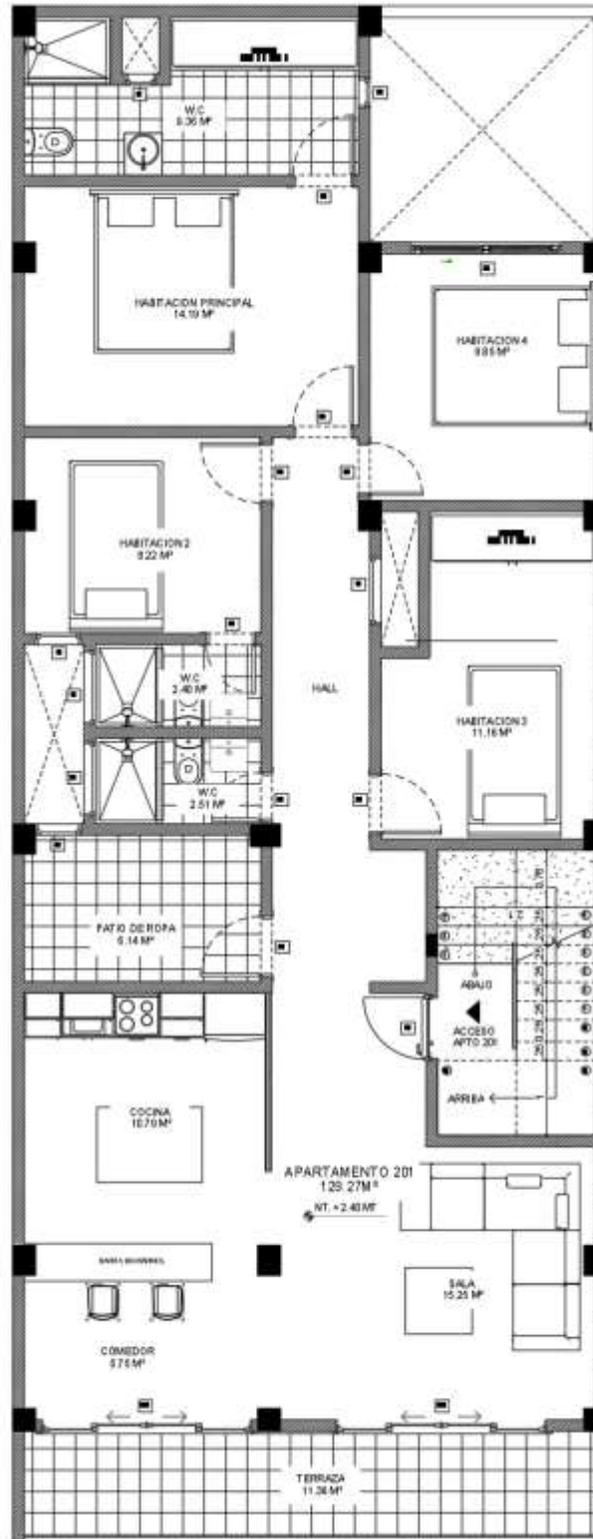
Plano arquitectónico planta Nivel 2 – Adoptado de: Reconstrucciones.
